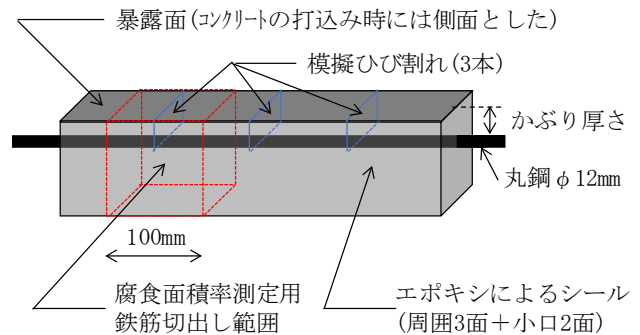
鉄筋コンクリート試験体(ひび割れあり)の詳細
